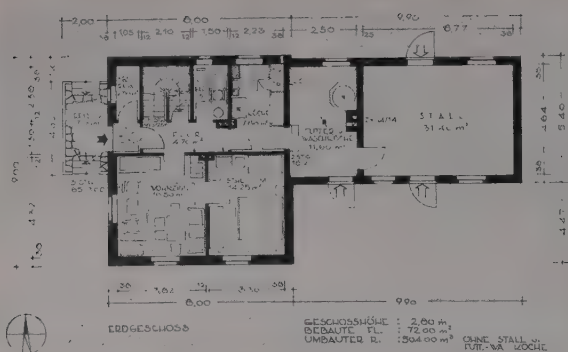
3 1/2-Zimmer-Einfamilienhaus mit angebautem Stall für Genossenschaftsbauern, Vorschlag für Mitteldeutschland, Grundriß Erdgeschoß
